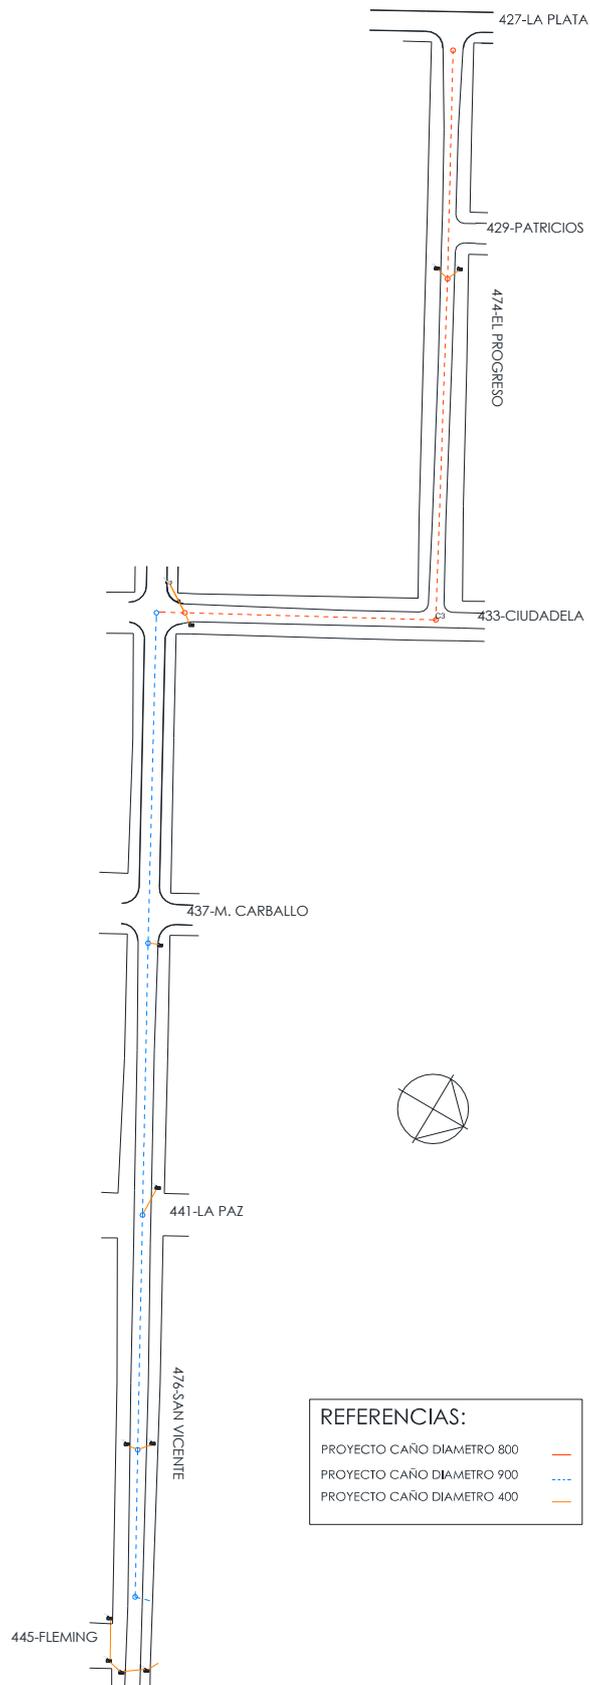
Desarrollo de la obra (entre las calles Fleming y La Plata)
